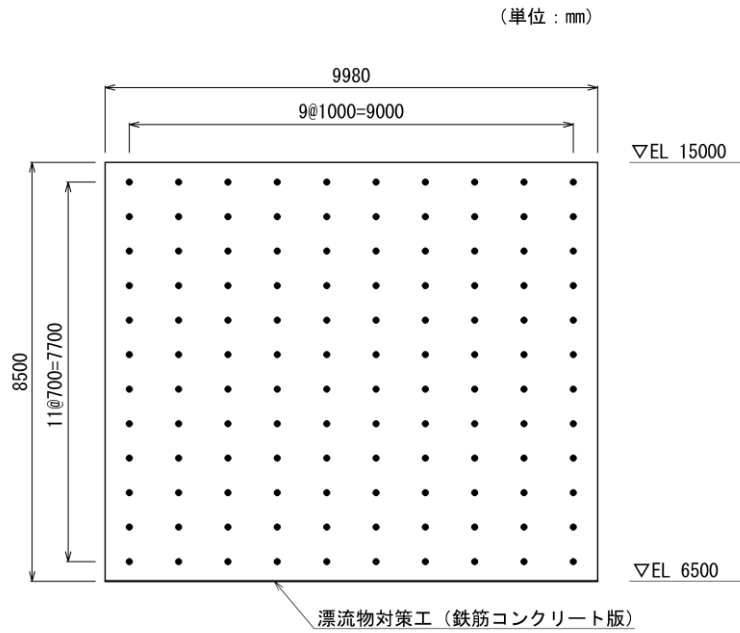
(1) 防波壁 (波返重力擁壁) 重力擁壁における漂流物対策工 (鉄筋コンクリート版) のアンカーボルト配置図 (正面図)
